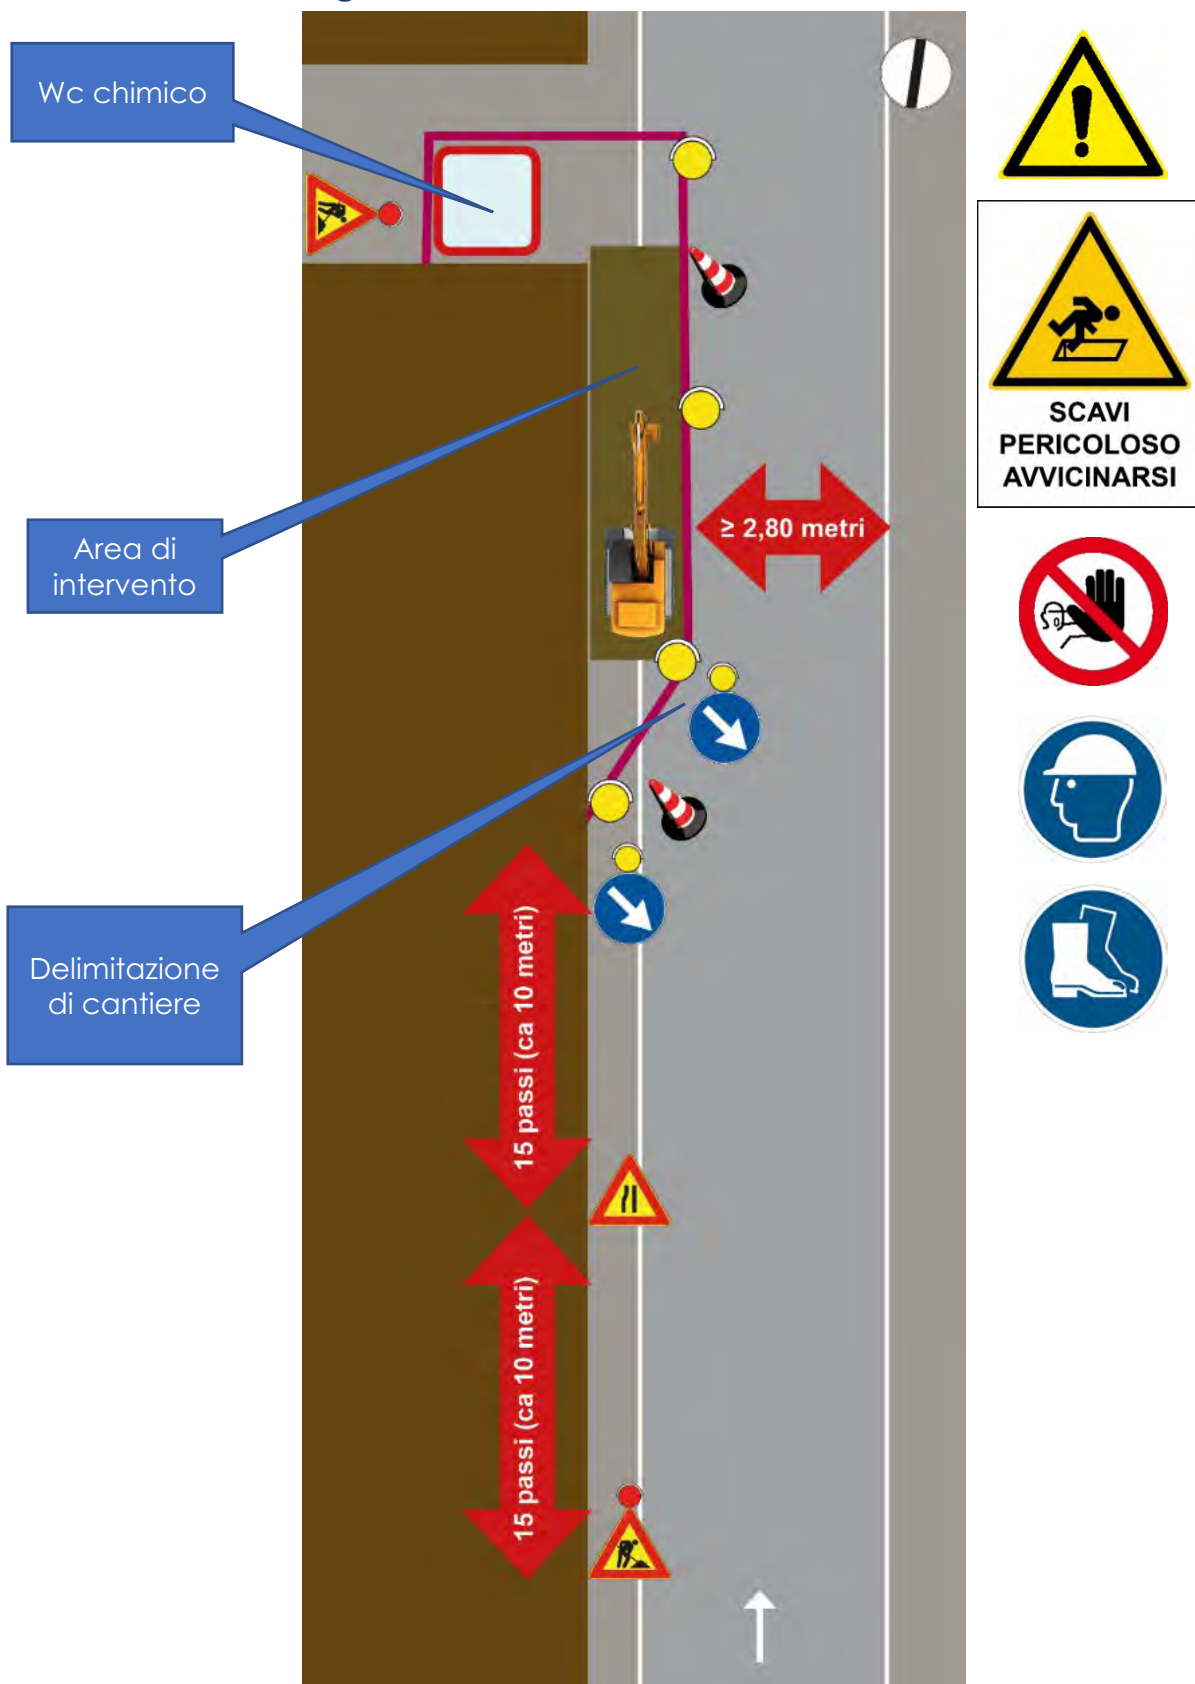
planimetria delle aree di cantiere con la segnaletica stradale installata
